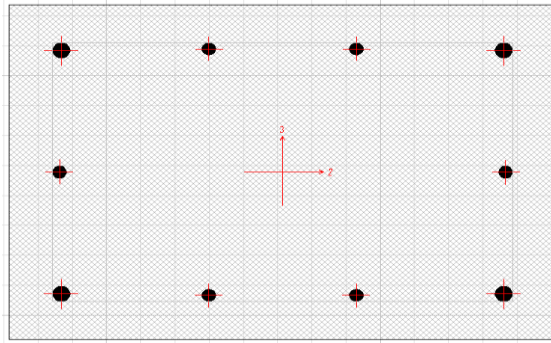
Sección de elementos estructurales. Fuente: Elaboración propia.
